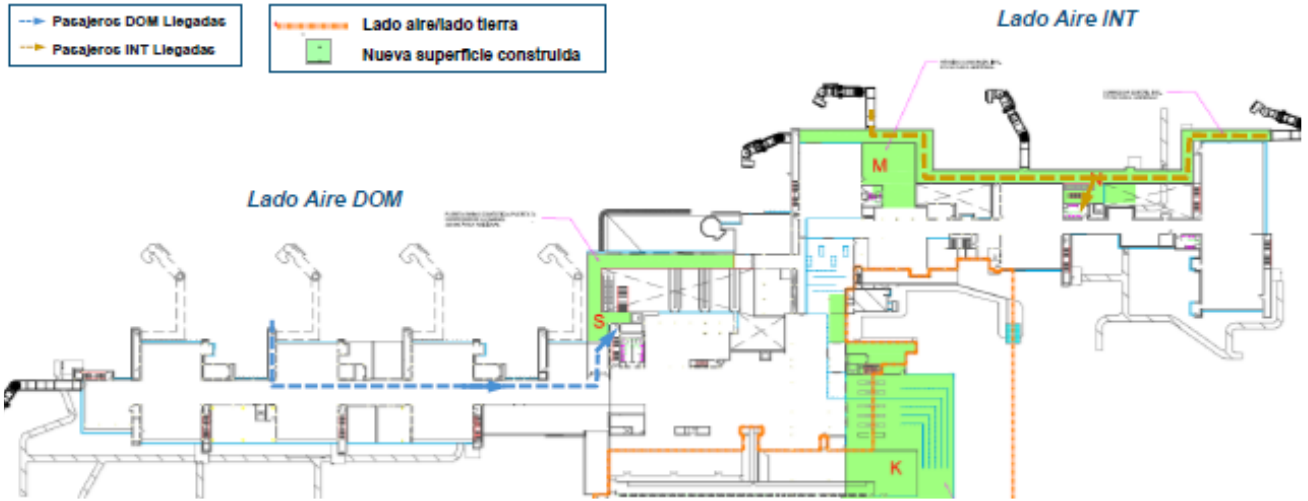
Emplazamiento corredor estéril muelle internacional. Fuente: Plan Maestro 2016.
